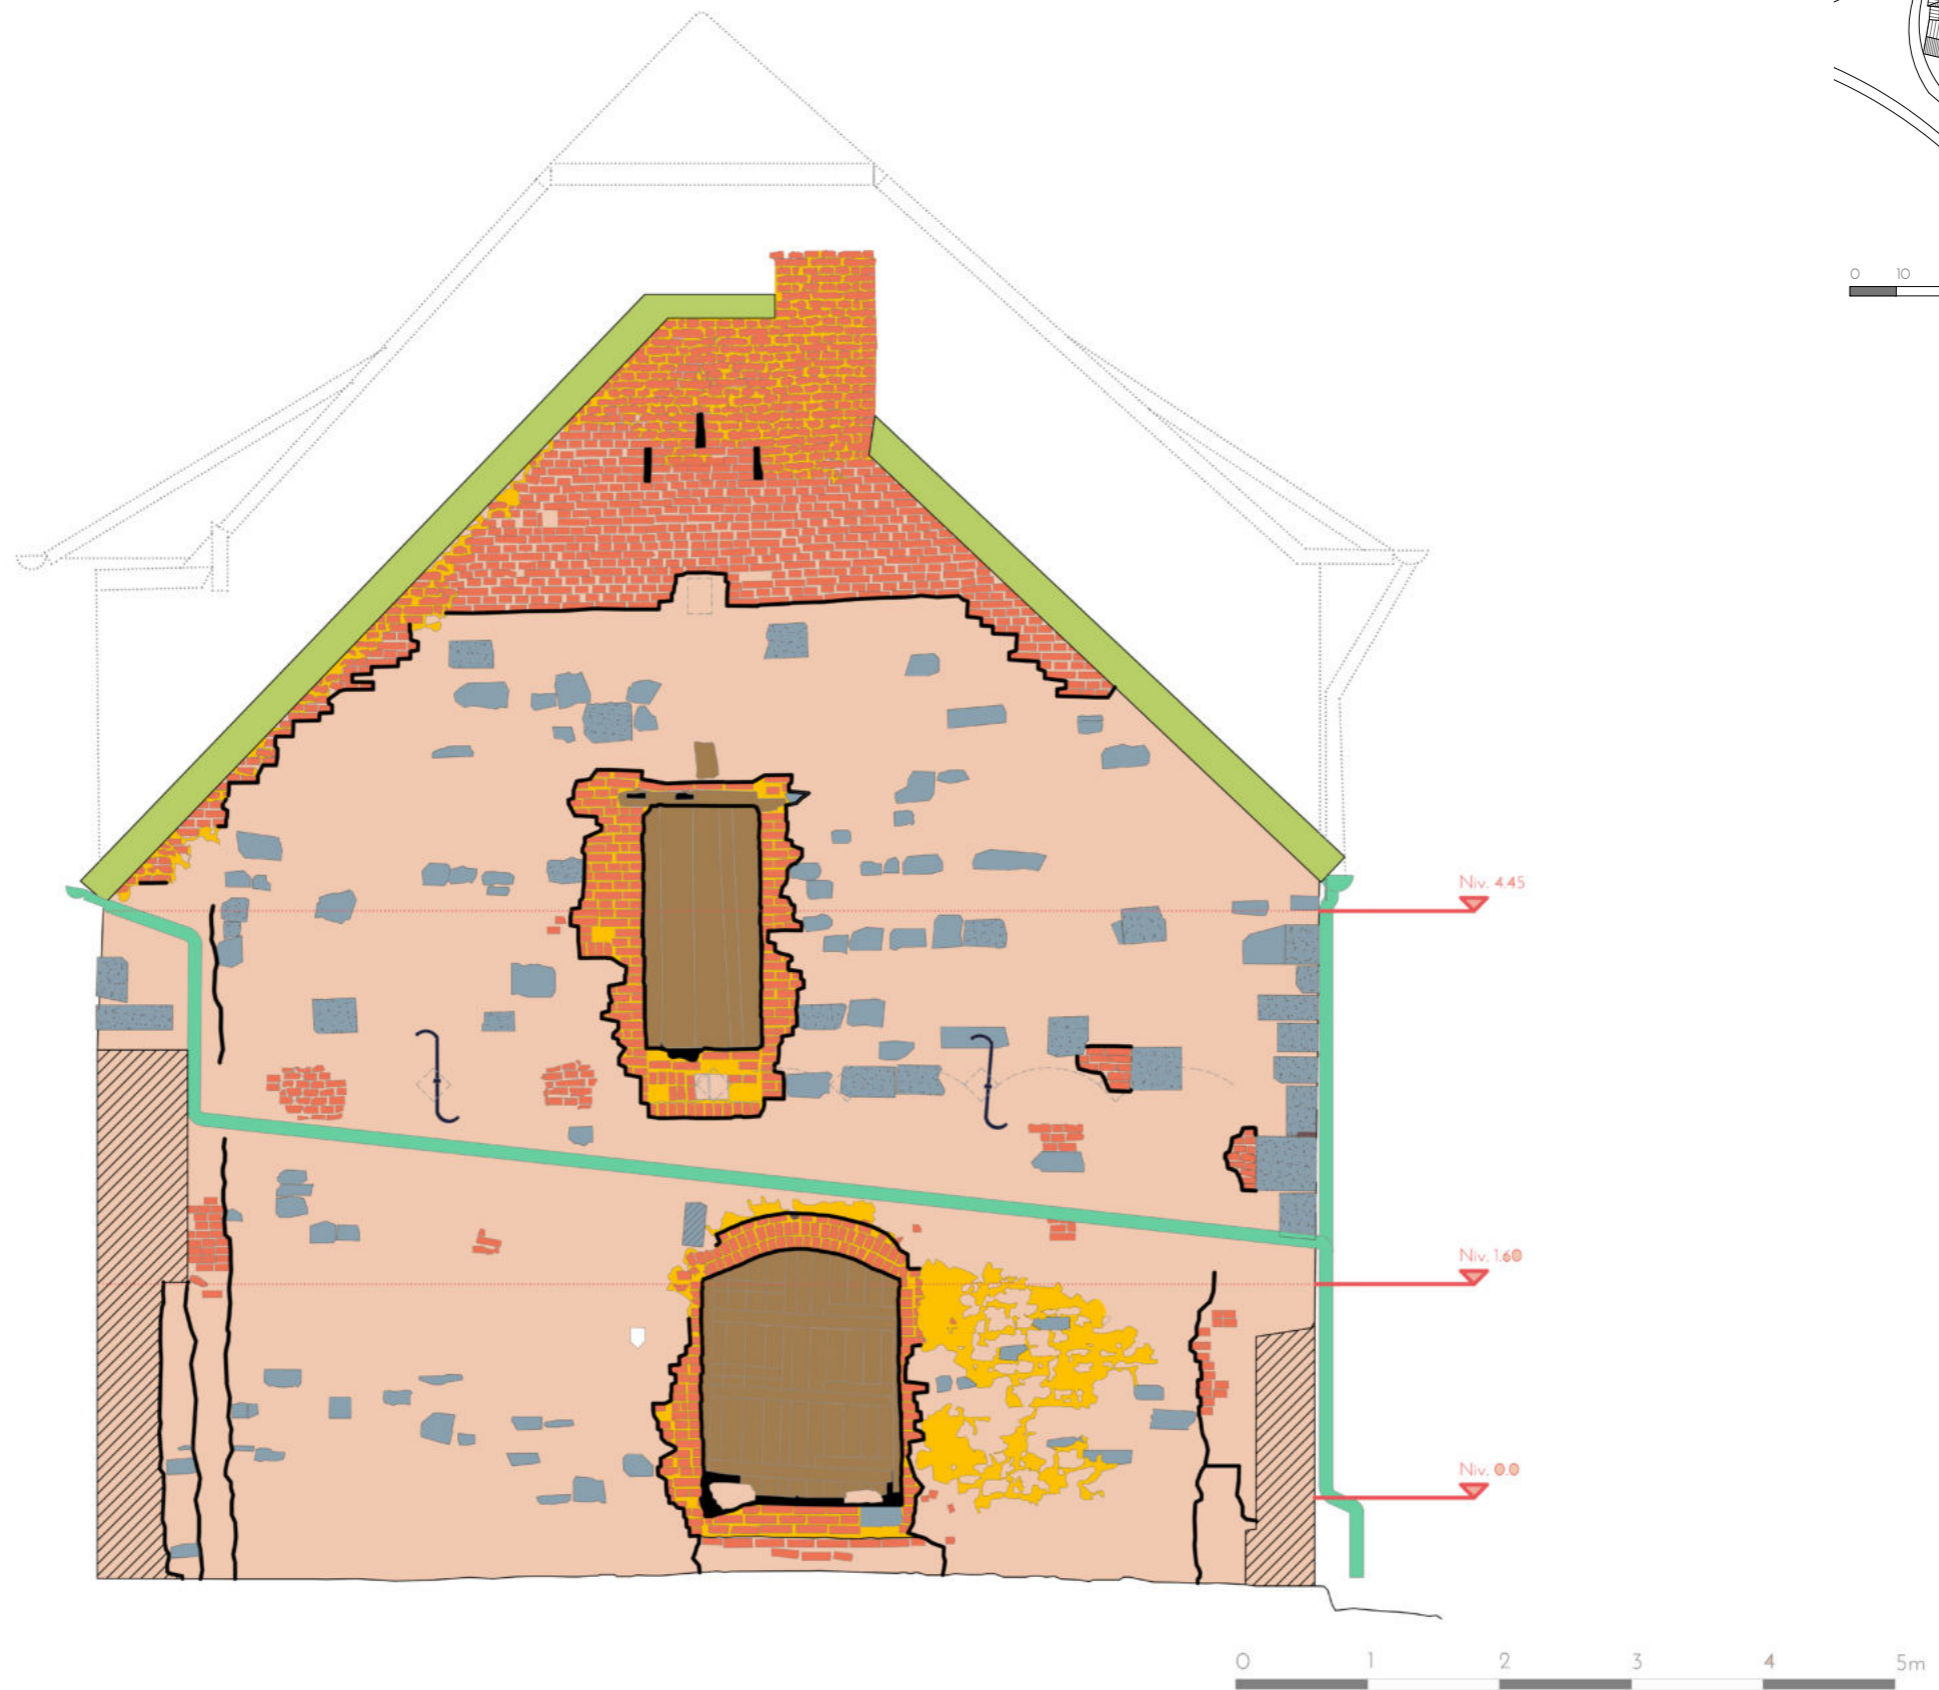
Elévation illustrant les matériaux employés. Façade ouest.
